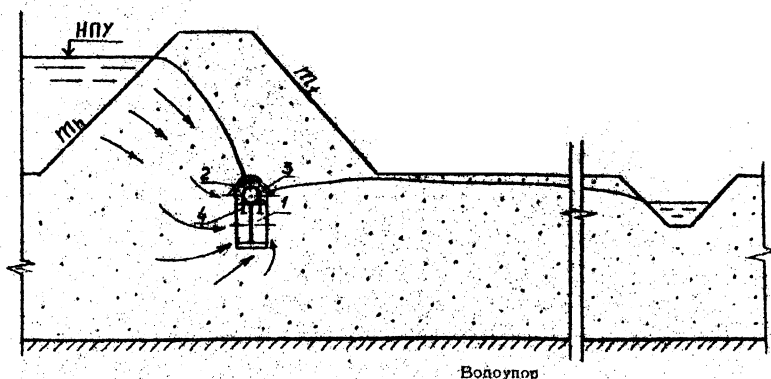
Дренаж земляных плотин на водопроницаемом основании
